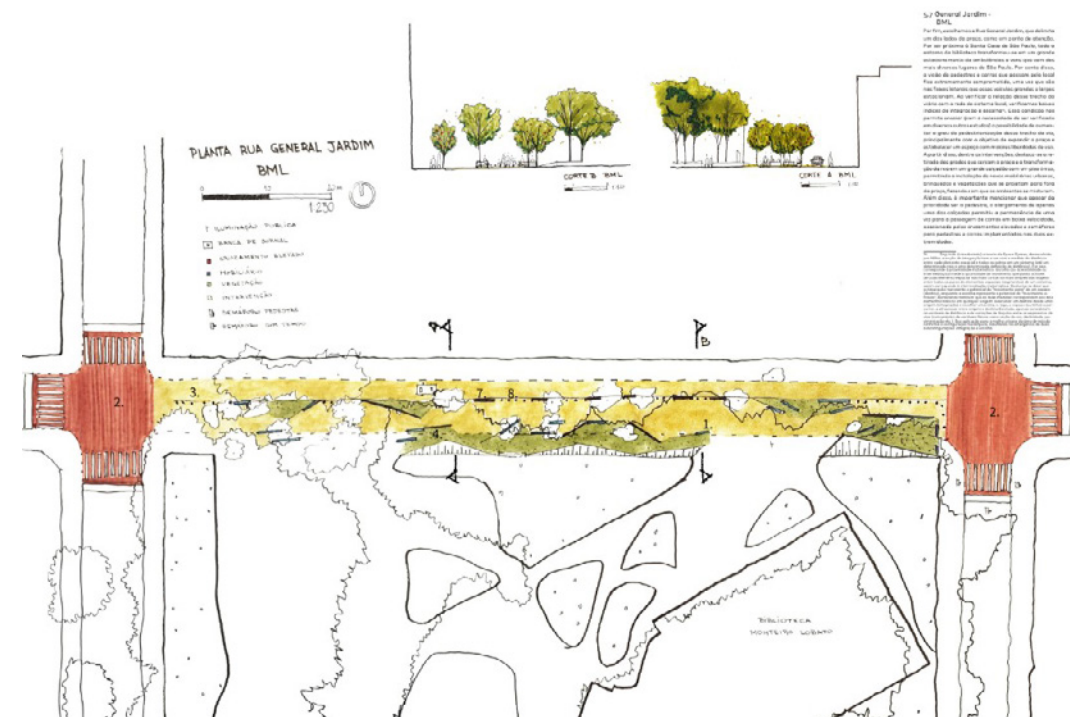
Planta e cortes da Rua General Jardim, próximo à Biblioteca Monteiro Lobato. Fonte: Elaborado pela equipe, 2023.
